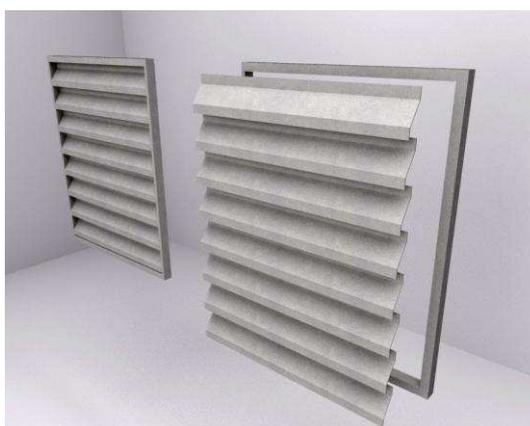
Brises fixados à viga e Sobreposição da viga aos brises.
